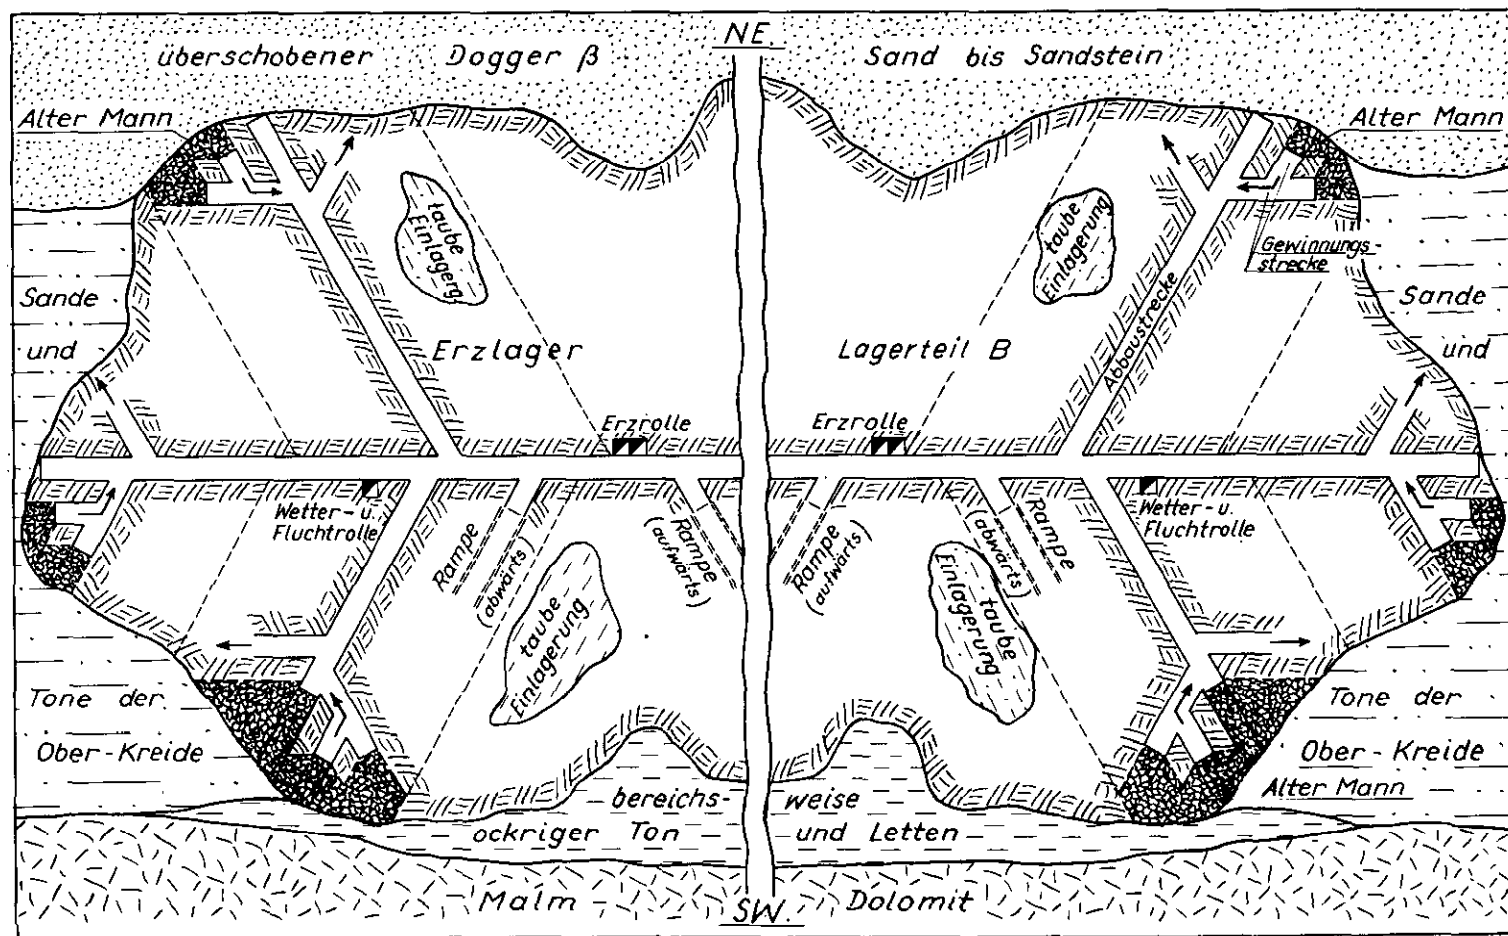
Abbau und Vertriebsweise auf dem Eisenerzbergwerk Auebach (Grundriß). – Aus PREUßER (1986: Abb. 6).
